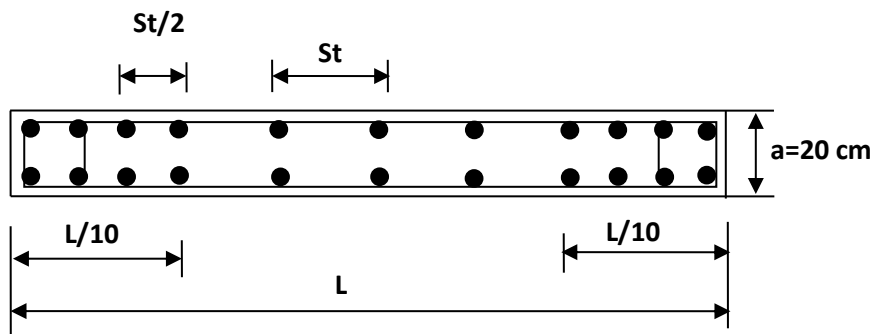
Disposition des armatures verticales dans les voiles.
